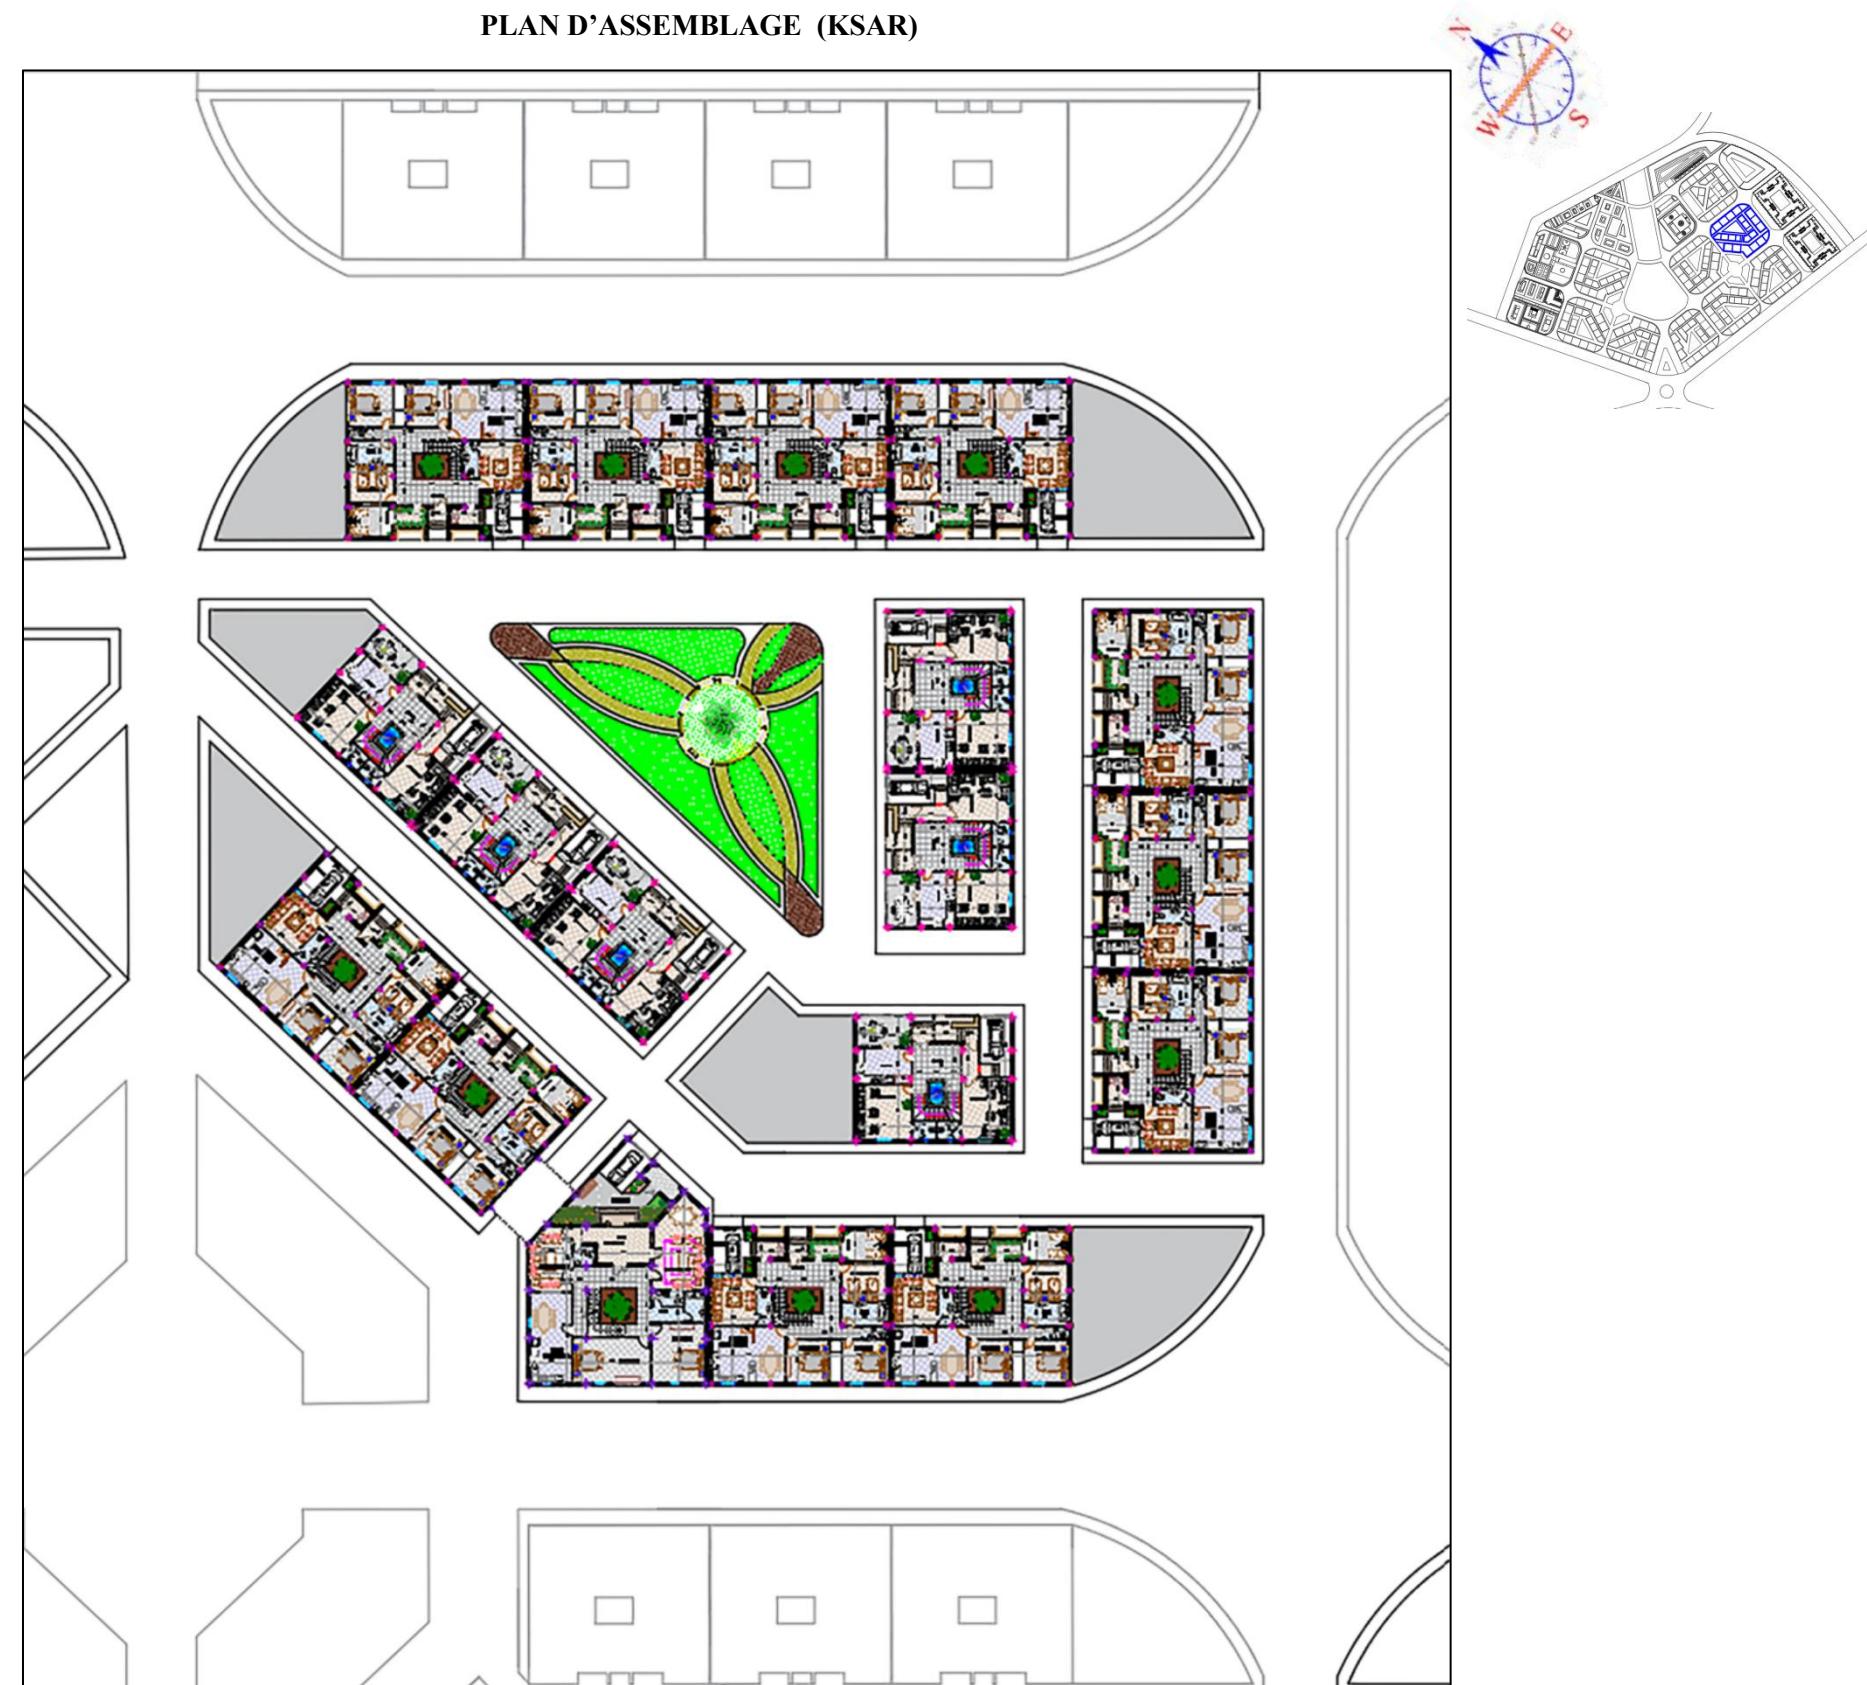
PLAN D'ASSEMBLAGE (KSAR) ; SOURCE: TRAITE PAR L'AUTEUR.
